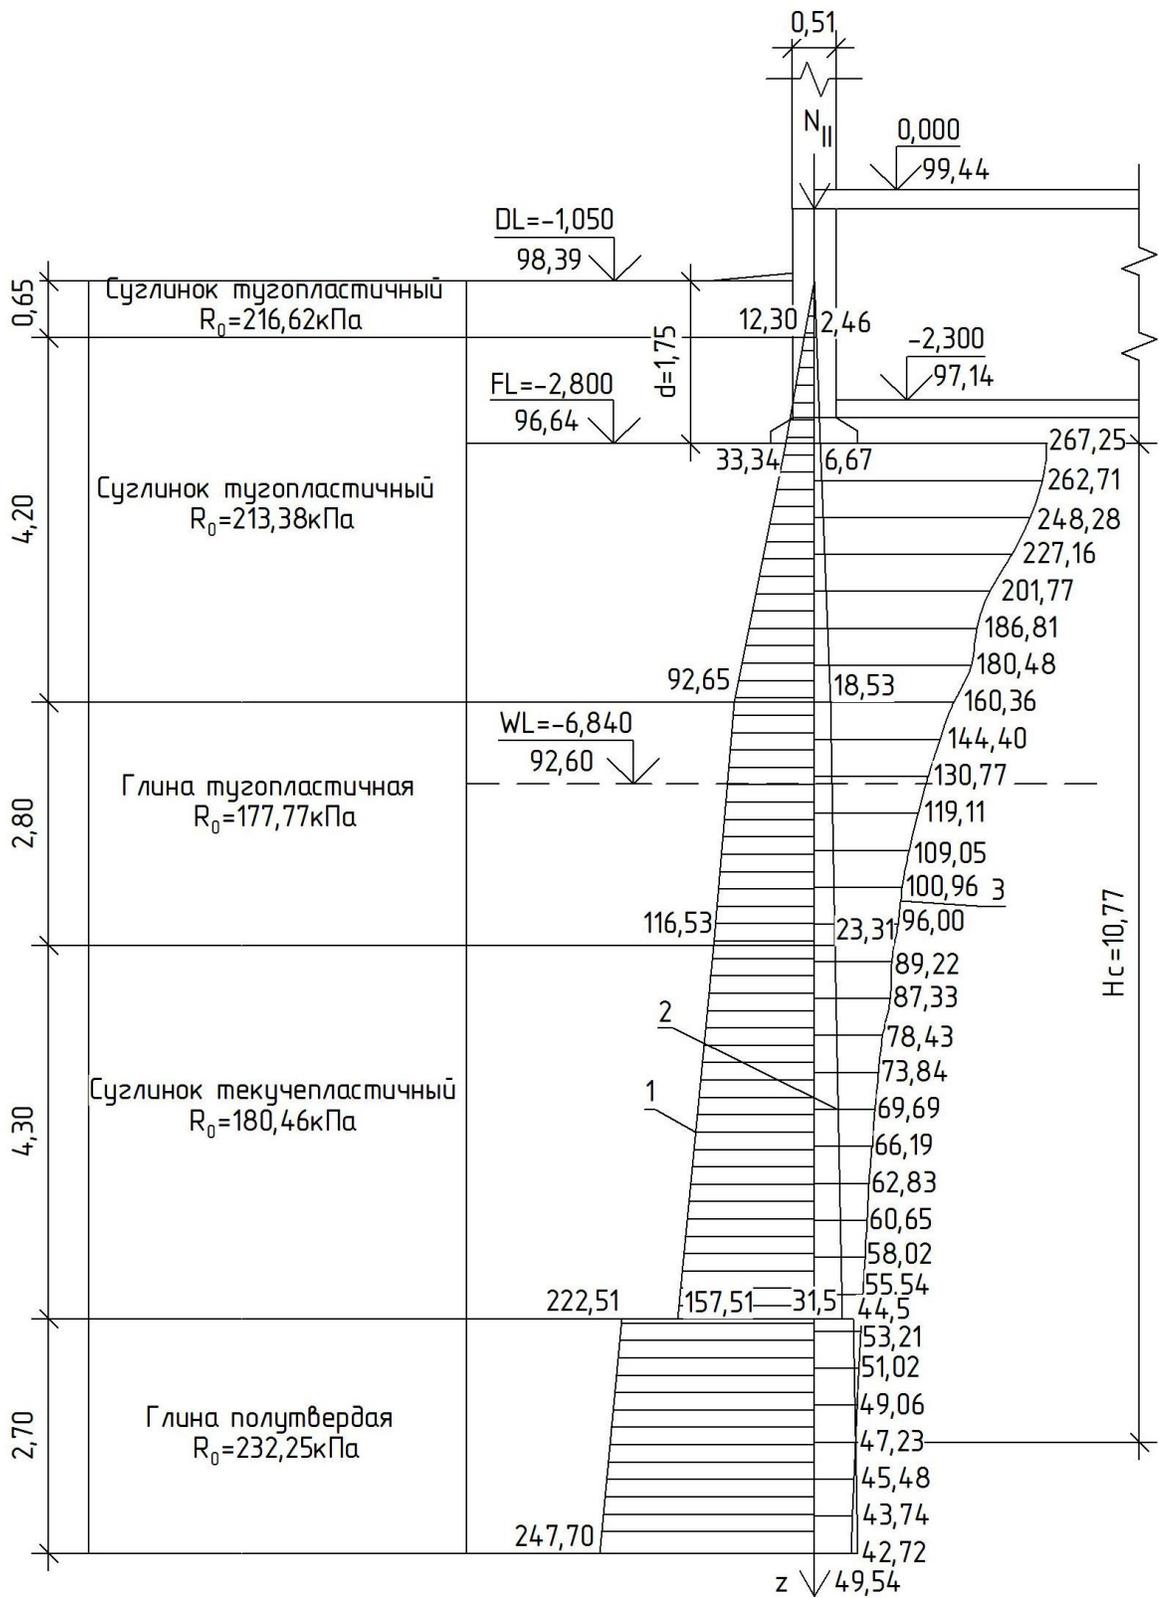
Схема к расчёту осадки по методу элементарного суммирования ленточного фундамента: 1 – эпюра природного давления, 2 – вспомогательная эпюра (0,2 от природного давления), 3 – эпюра дополнительного давления
